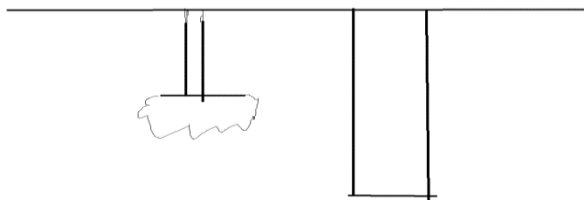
Фундаментная система из грунтобетонного подпятника и колонны
